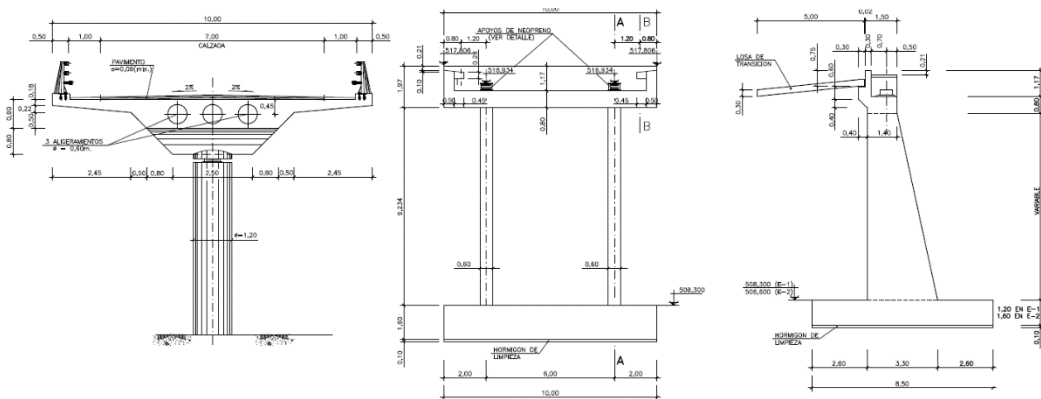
Alzado de las pilas y estribos de las estructuras 3, 4 y 5
